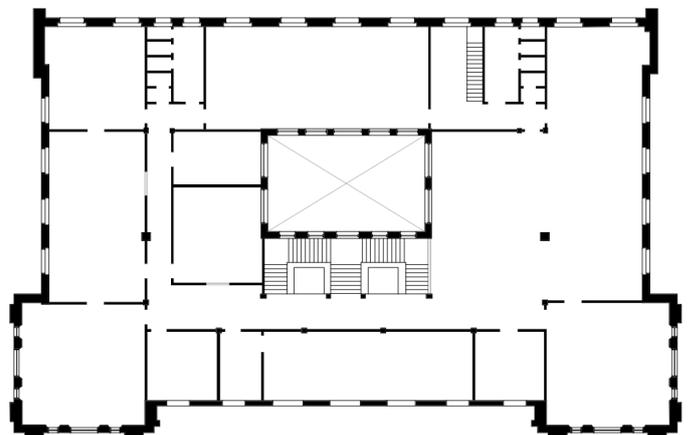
Redesenho planta do 3º andar, Secretaria de Obras Públicas, 1944.
